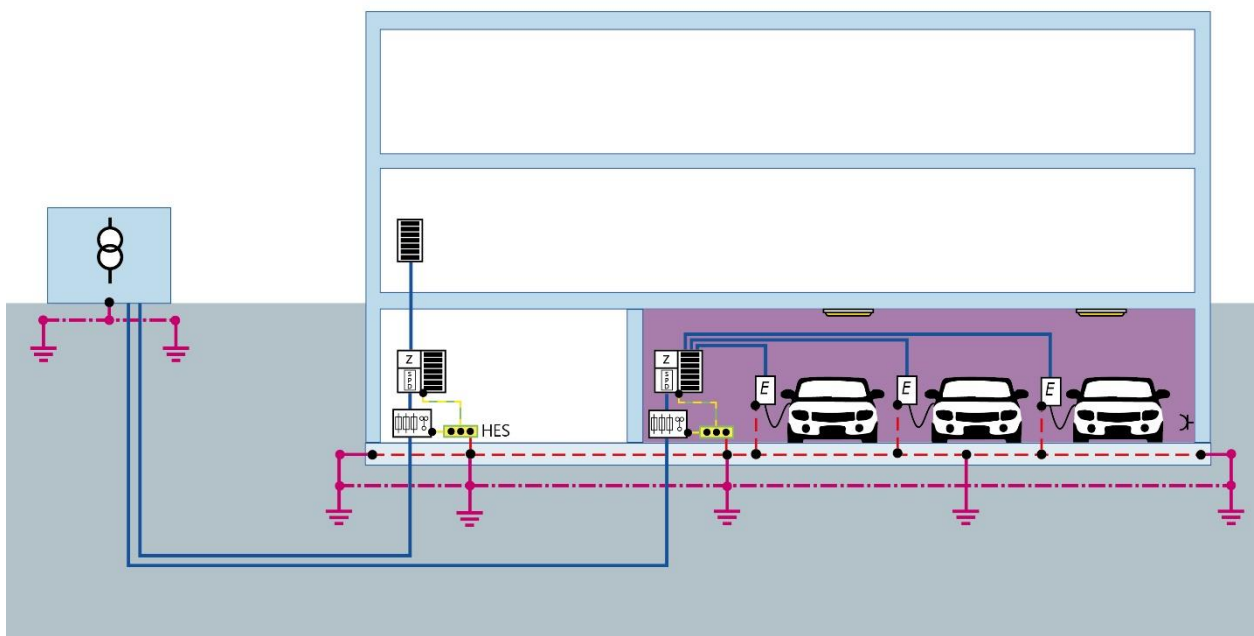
Ladestation mit baulich abgegrenzter Kundenanlage
